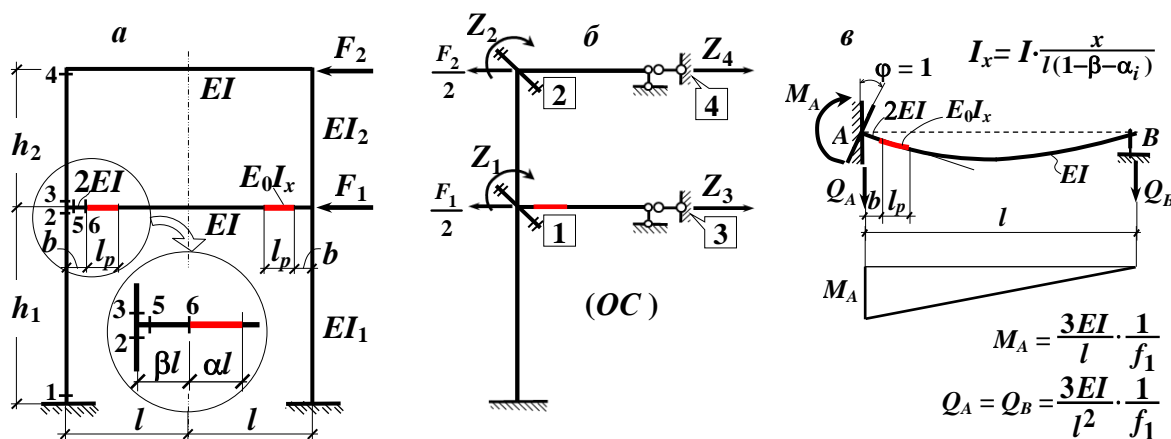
Расчетная схема 2-этажного каркаса с ПЗ в ригеле первого этажа (а); б – основная система МП с учетом симметрии каркаса; в – деформированное состояние балки с ПЗ при единичном повороте жесткого узла
